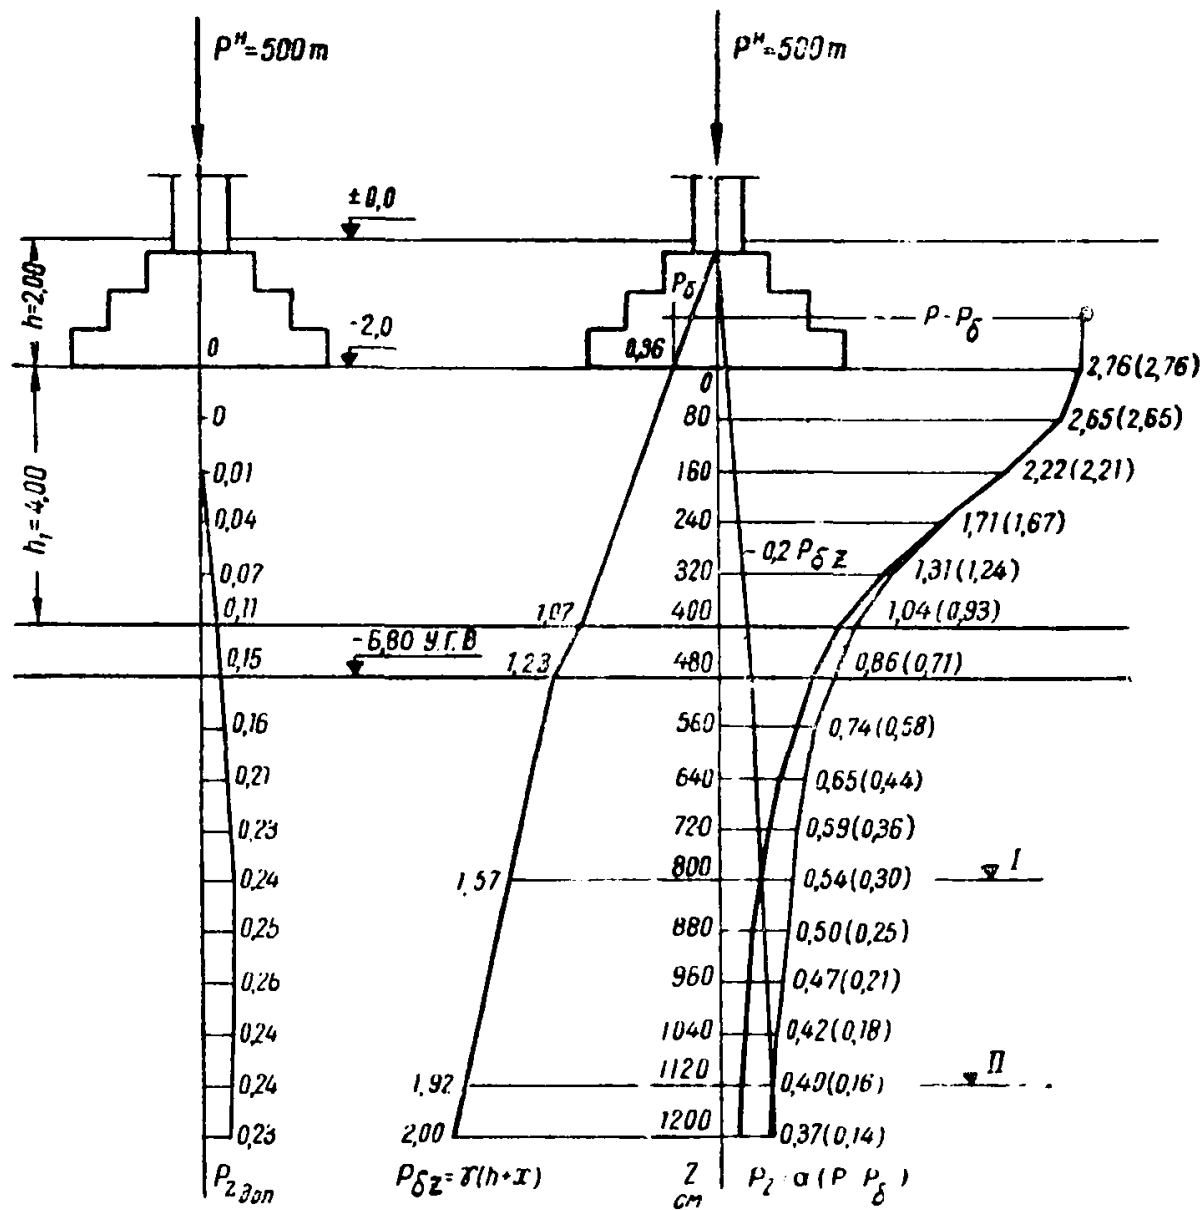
Схемы для расчета осадки фундамента с учетом влияния соседнего фундамента
